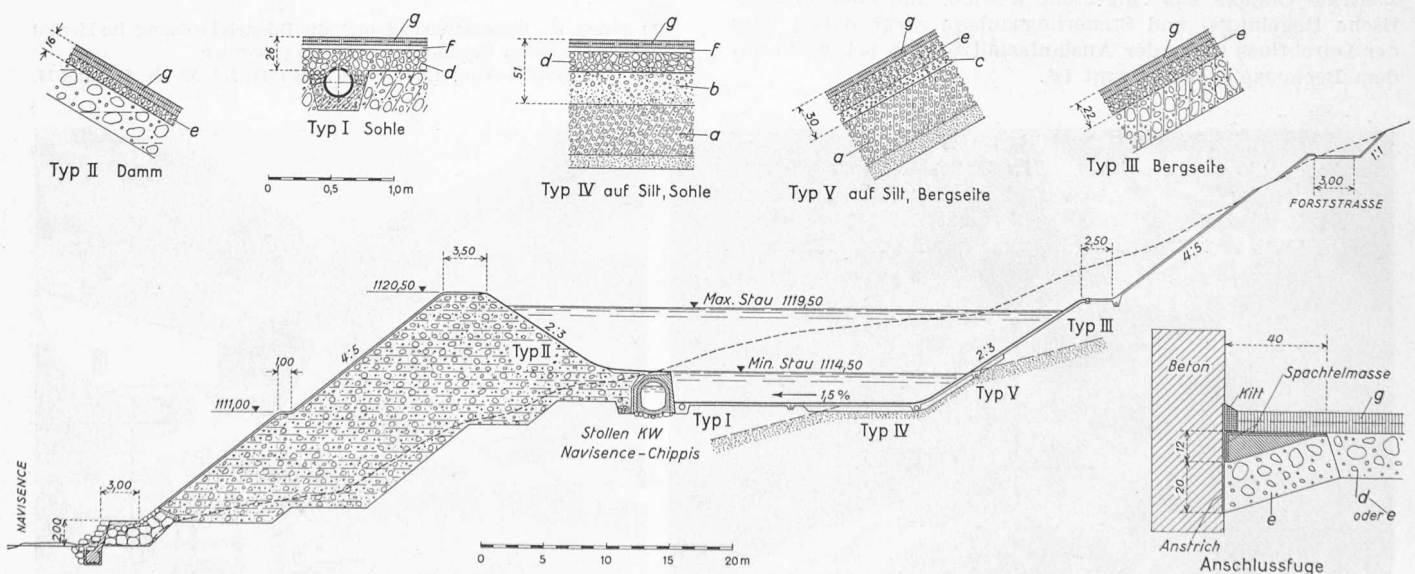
Becken-Querschnitt 1:600, Schnitt Anschlussfuge 1:30 und Ausbildungstypen für Belag und Untergrund 1:60. a) Koffer, Kies ab Wand rd. 50 cm. b) Filter, Grobsand 15 cm. c) Filter (Makadam) 8 cm. d) Drainagekies 20 cm. e) Drainagemakadam, Einschnitt 14 cm, Damm 8 cm. f) Oberflächenbehandlung. g) Dichtungsbelag, Böschung 2x4 cm, Sohle 2x3 cm
